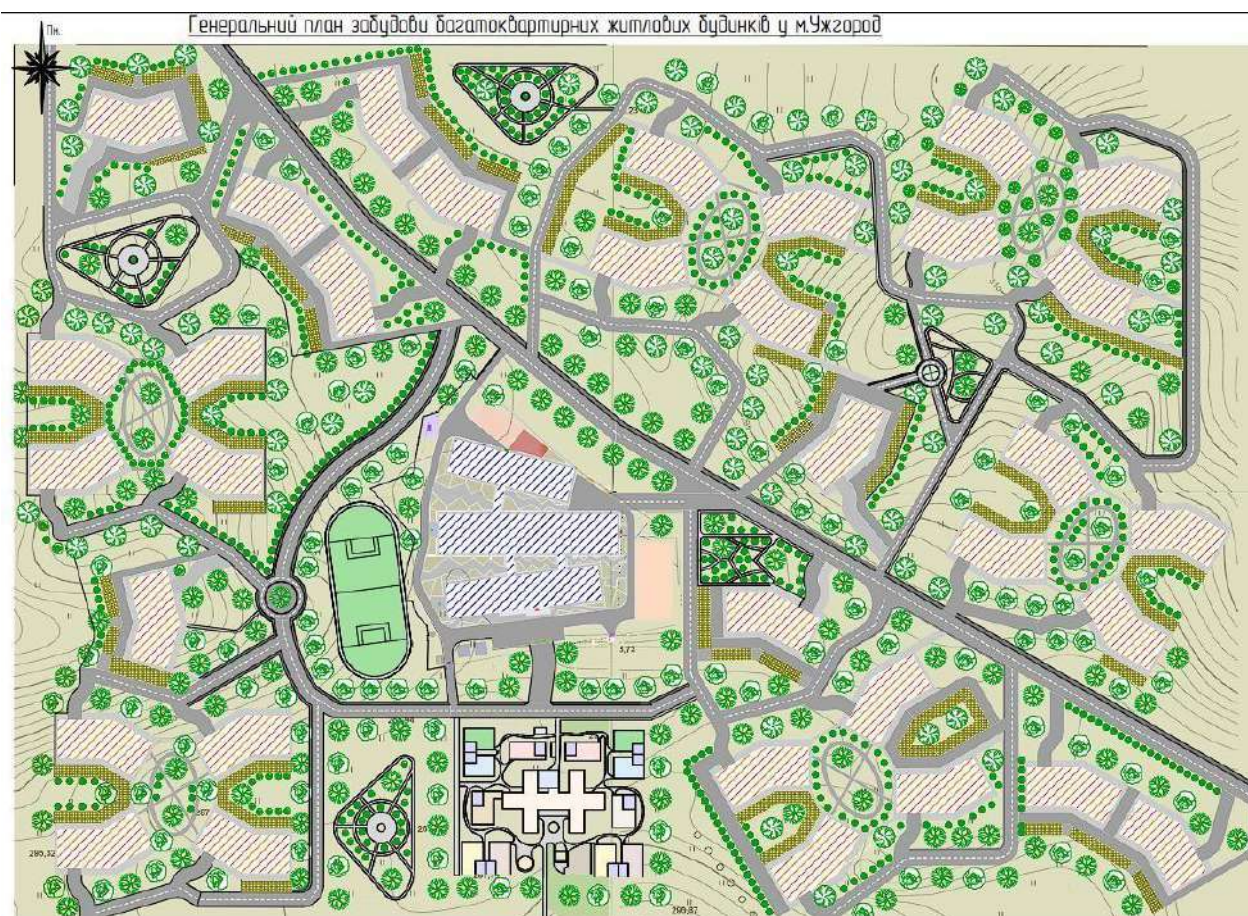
Генеральний план забудови багатоквартирних житлових будинків у м. Ужгород
